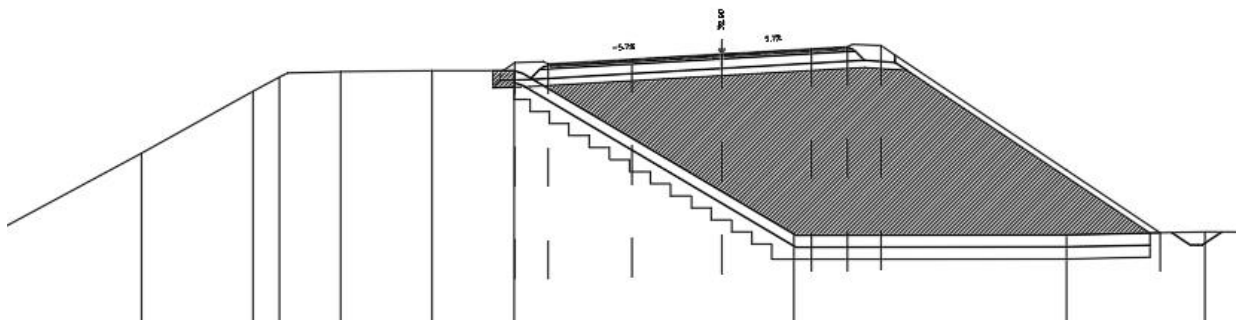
Sezione B1 del rilevato di appoggio alla spalla B, tra pk 1+096 e pk 1+140
